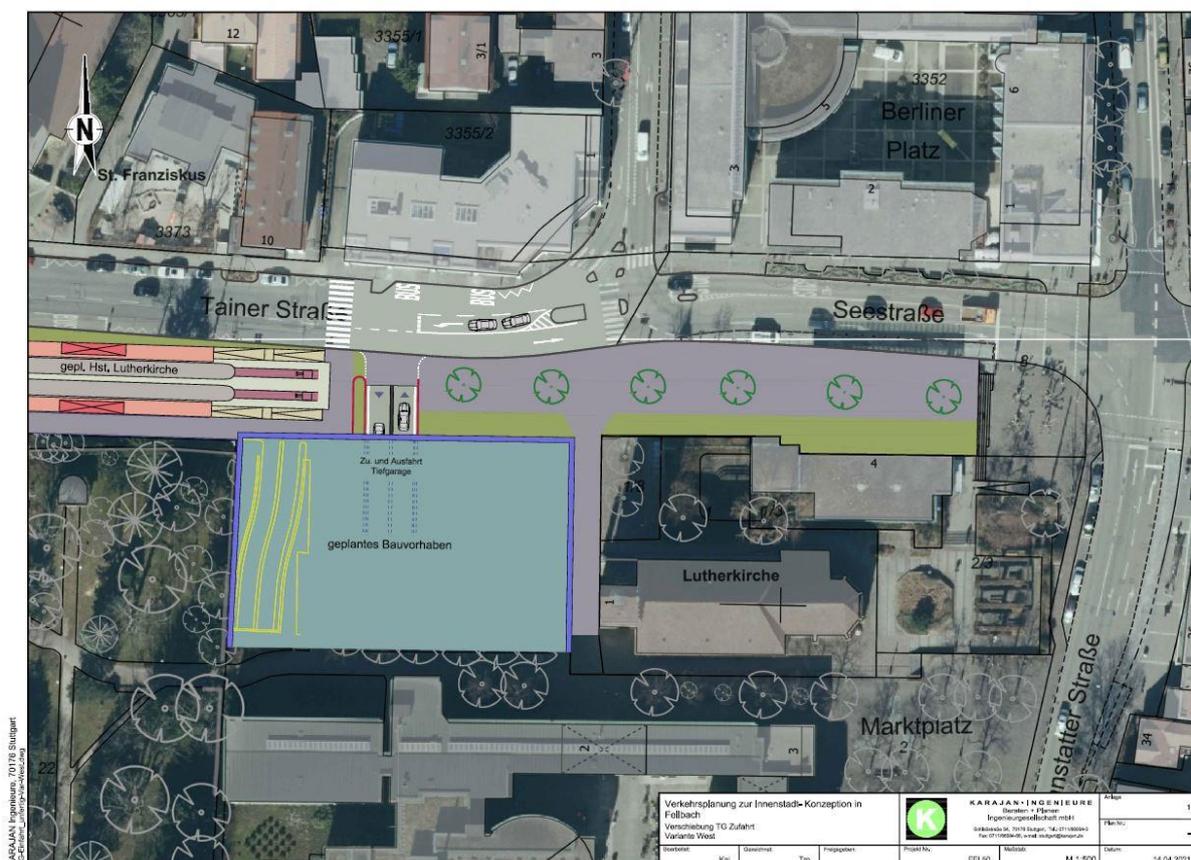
Tiefgaragenzufahrt Planfall 6
